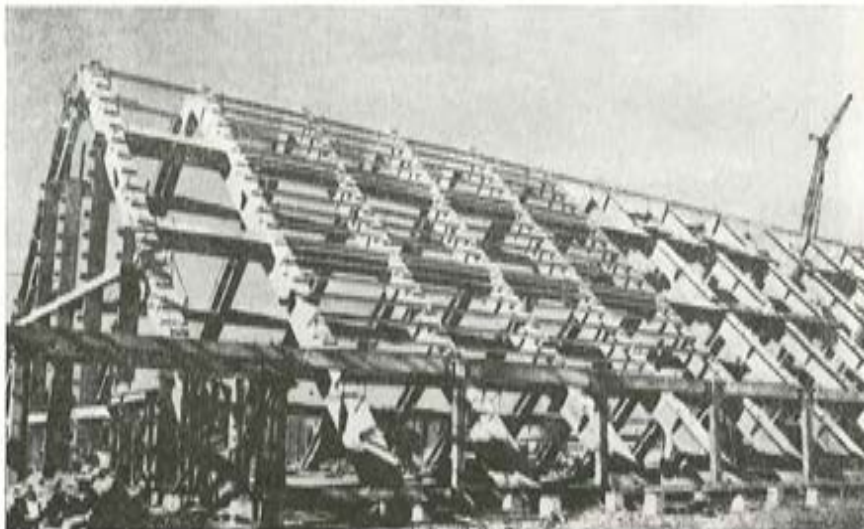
Factoría de FERTIBERIA (Castellón)
